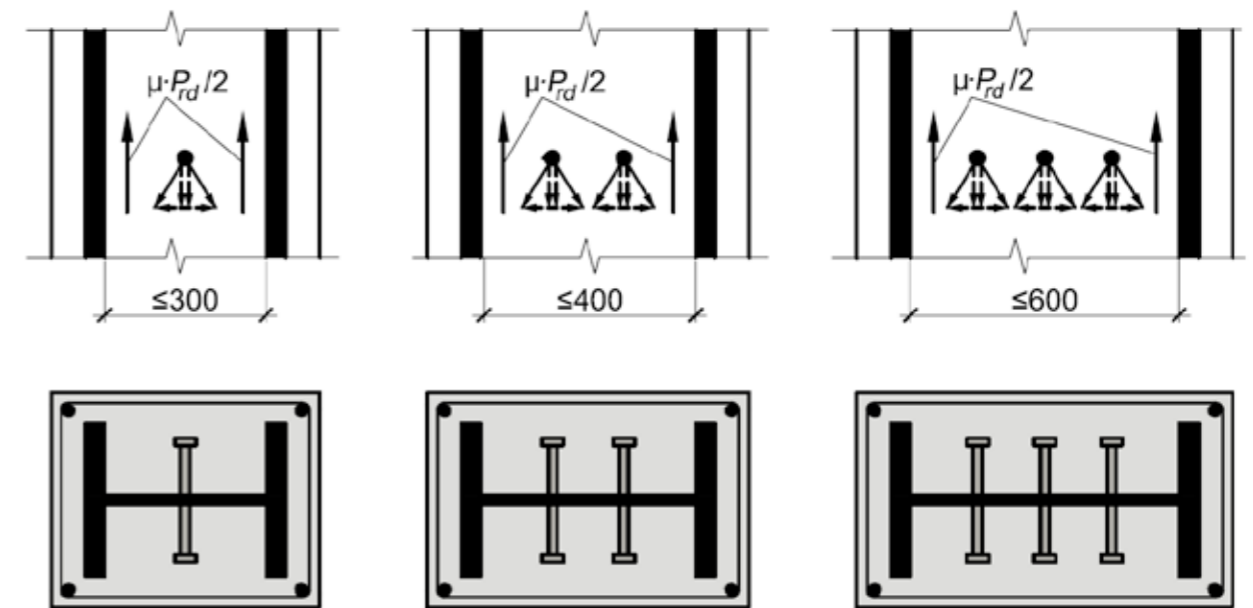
Схемы установки гибких упоров в сталежелезобетонном элементе на примере сечения с жесткой арматурой двутаврового очертания.2 Стад-болты и уголковые упоры
